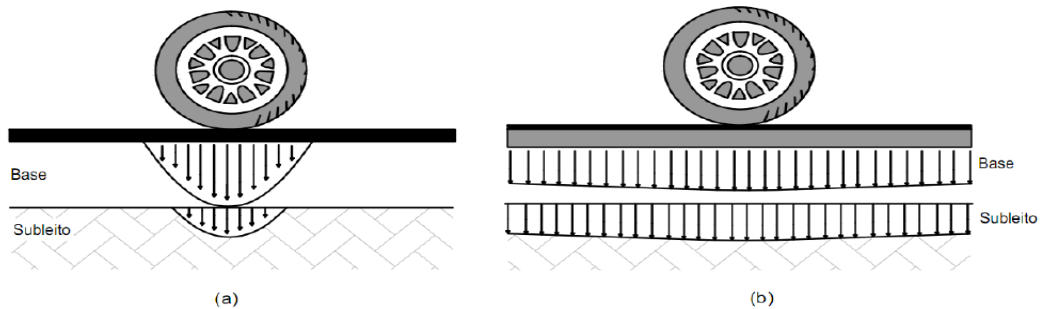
(a) campo de tensões de pavimento flexível ; (b) campo de tensões de pavimento rígido
